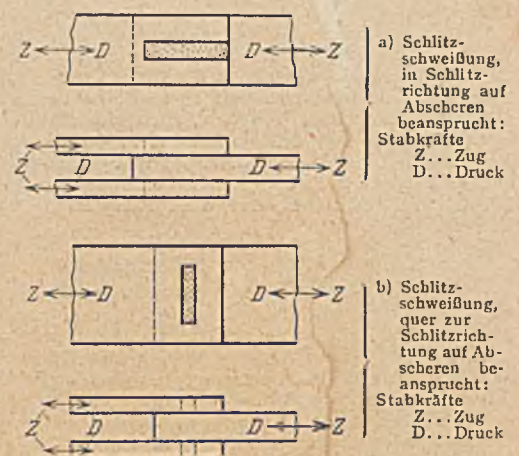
Belastungsarten für Schlitzschweißung.
